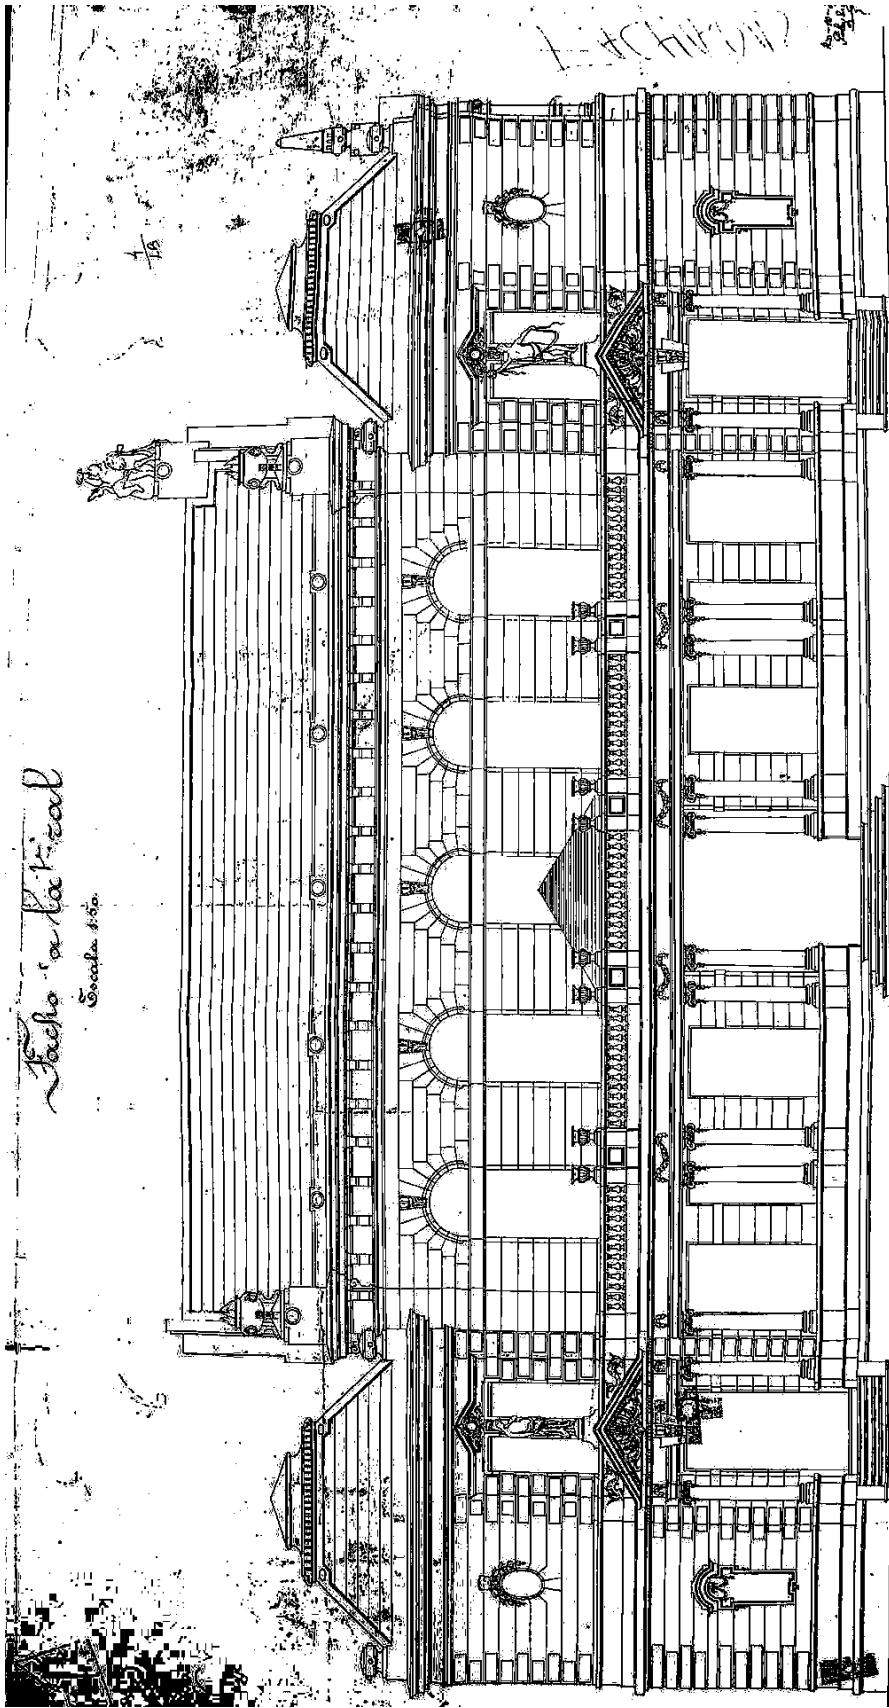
Projeto Fachada Lateral do Cassino do Lago, 1909
